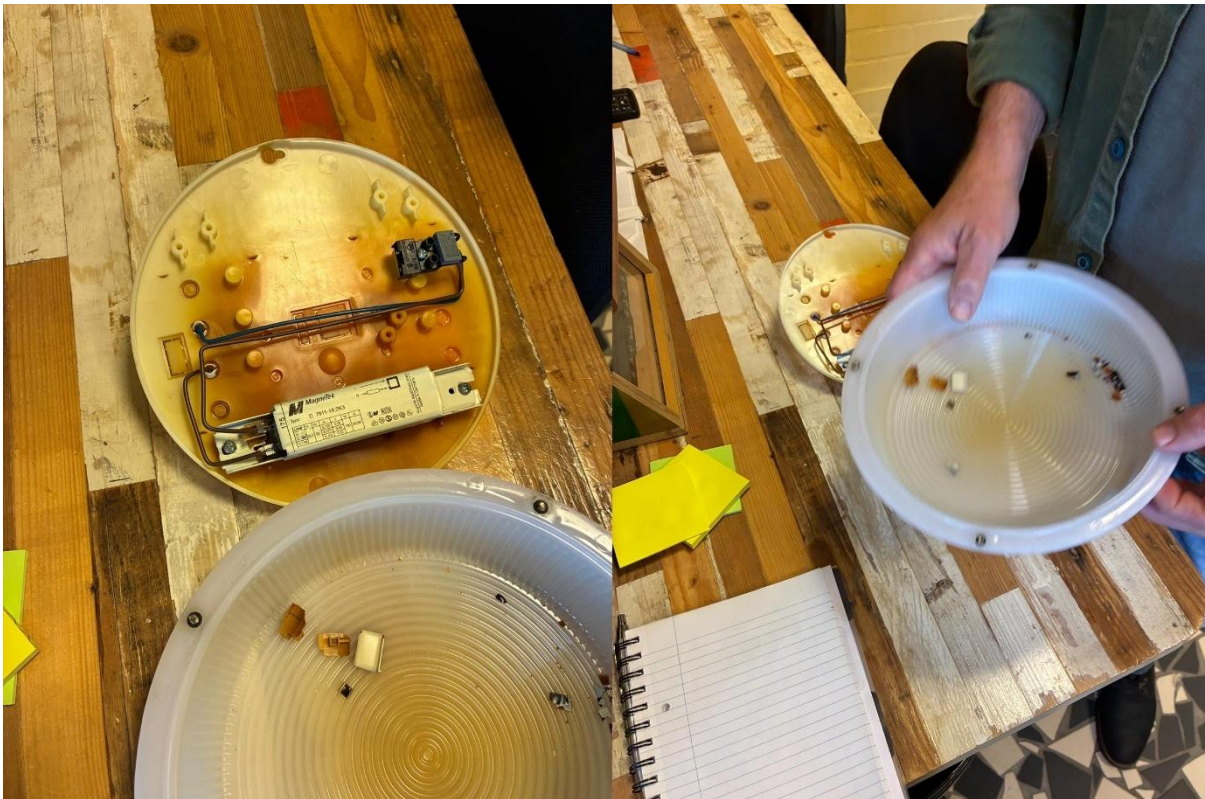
Detailfoto van lampen toiletruimtes na defect Tavenu
